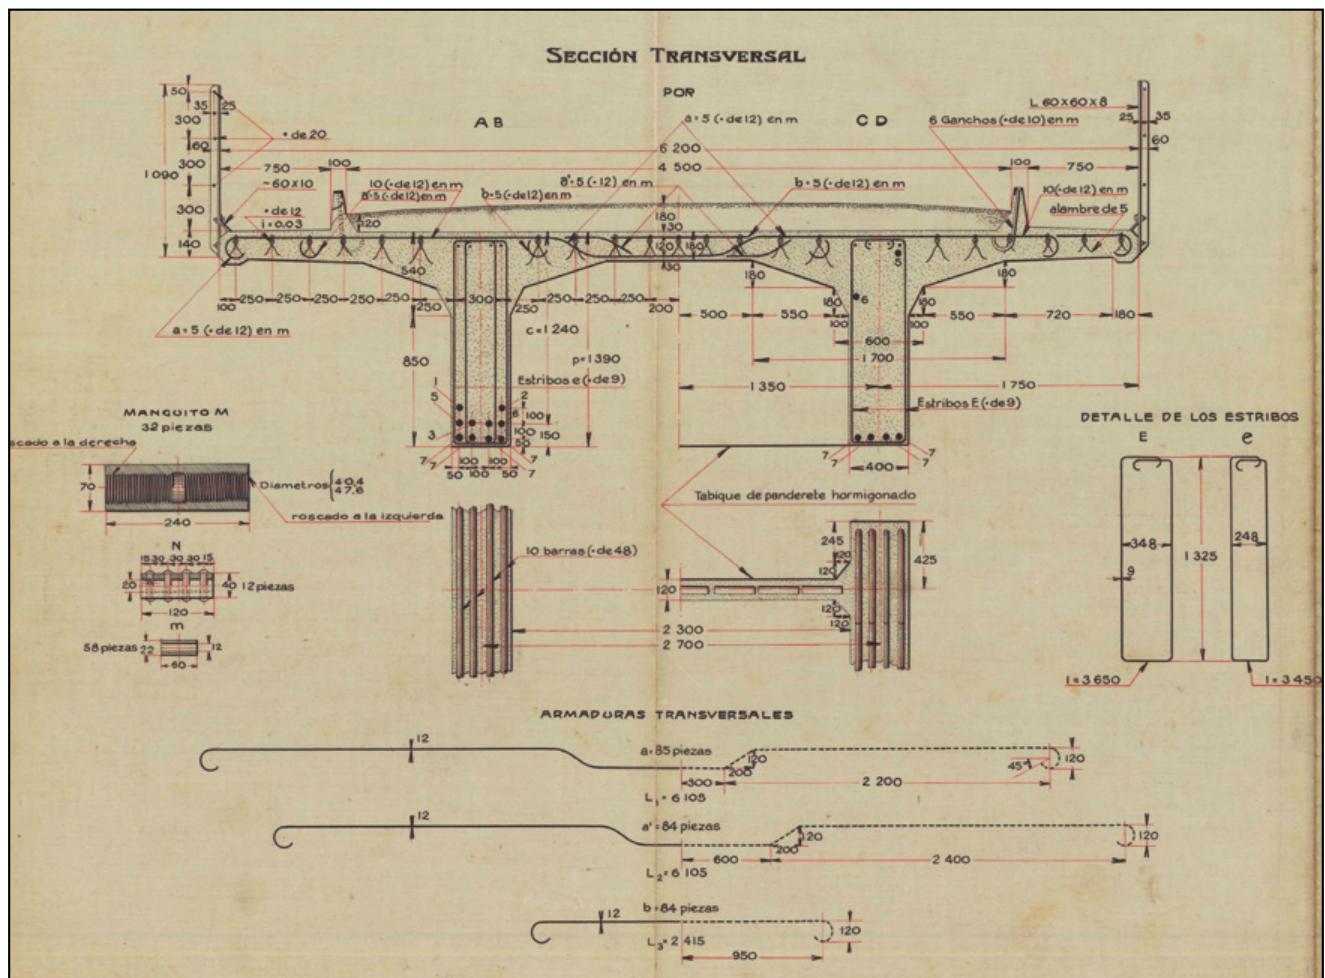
Tramo de losa nervada para puentes de 16 m de luz. Colección de modelos de puentes de hormigón armado para carreteras. Archivo General del Ministerio de Fomento, Madrid.
